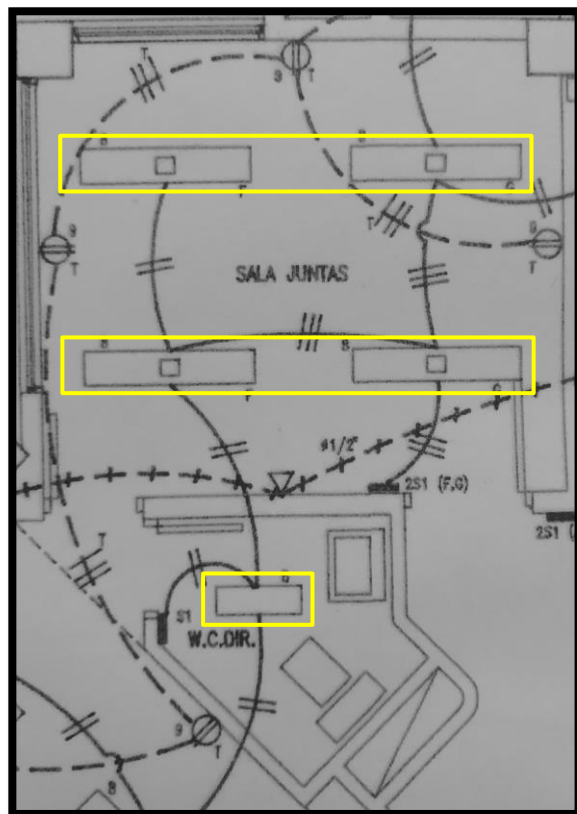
Cornare. (2008). Plano de Distribución del Sistema Eléctrico Planta Segundo Piso.
